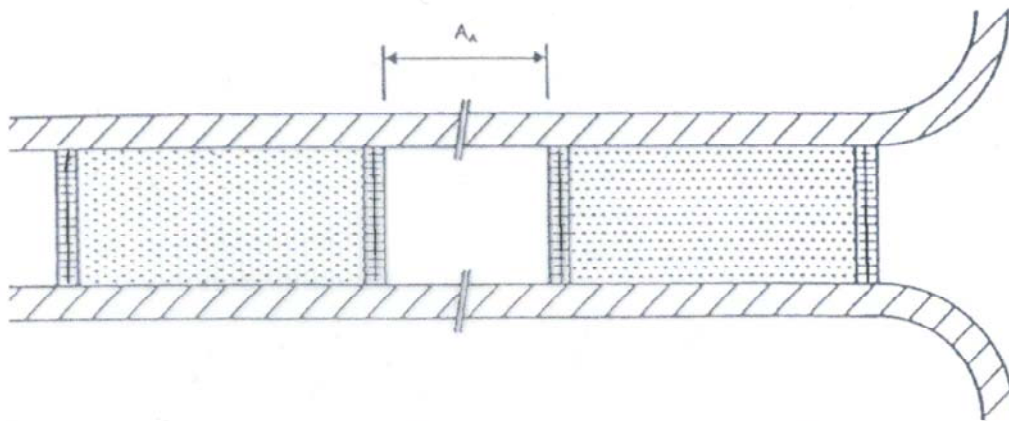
Schema di una successione di elementi di sopraelevazione della pavimentazione stradale
